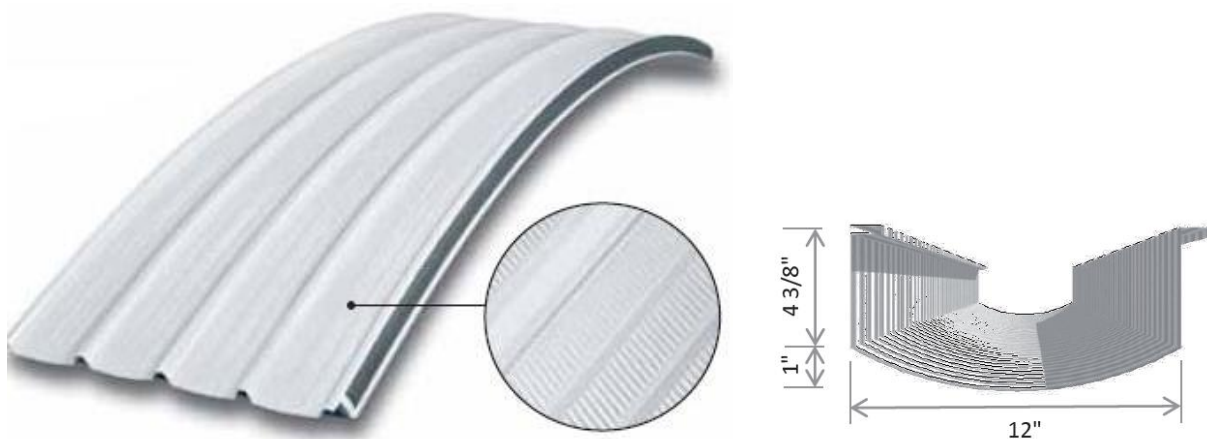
Detalle de cubierta de techo autoportante.
